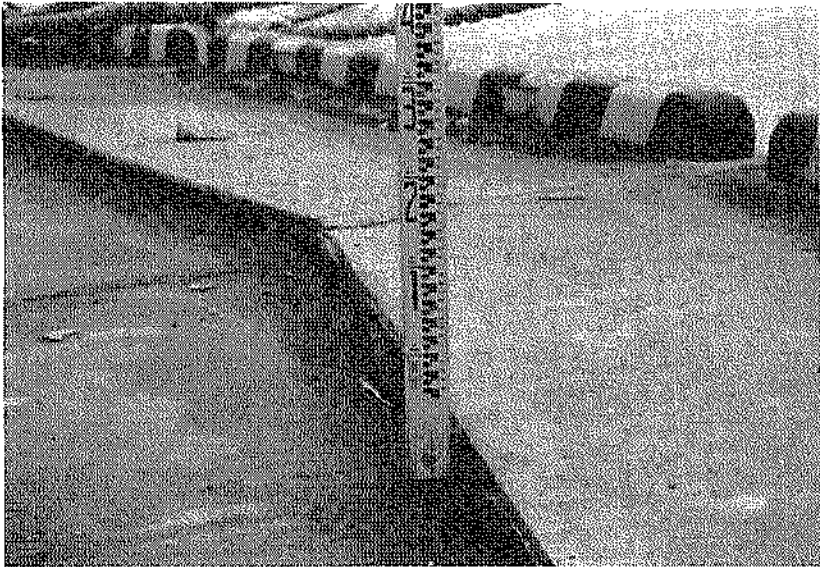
中央埠頭地区, ⑤壁取付部(-10.0m)
